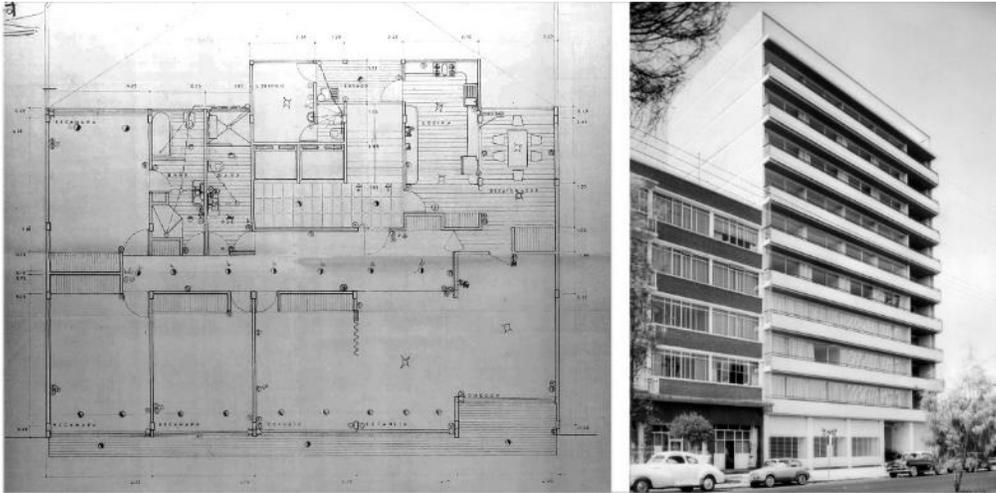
Plano de planta tipo –detalle-, febrero 1959, y vista de la fachada del edificio ubicado en Newton núm.156, ca.1961
